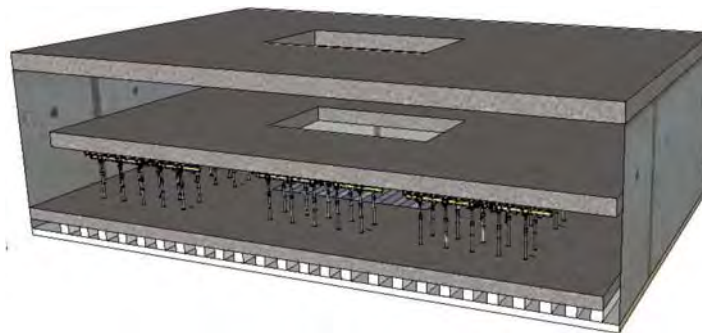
Colocación de cimbra para colado losa sótano uno.
